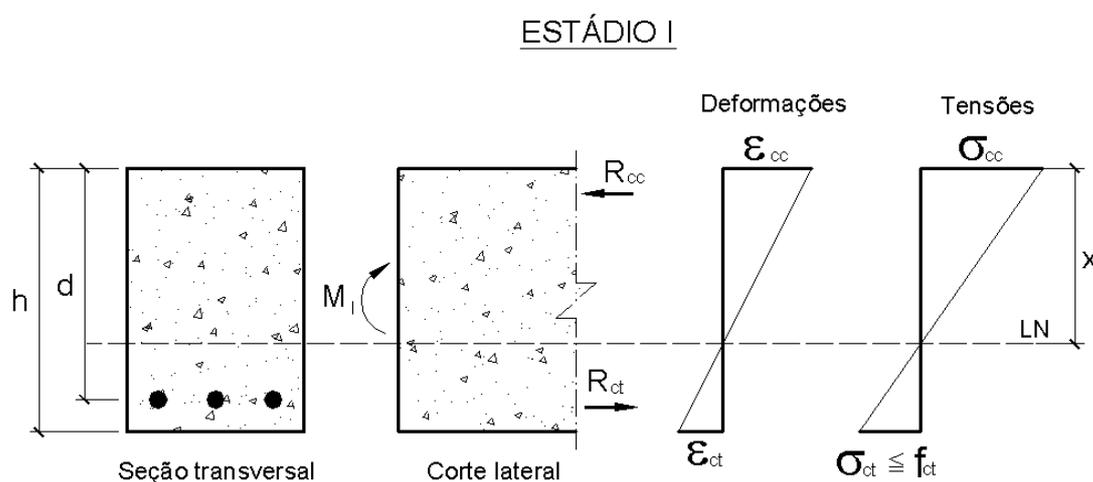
Comportamento do concreto na flexão pura (Estádio I)
